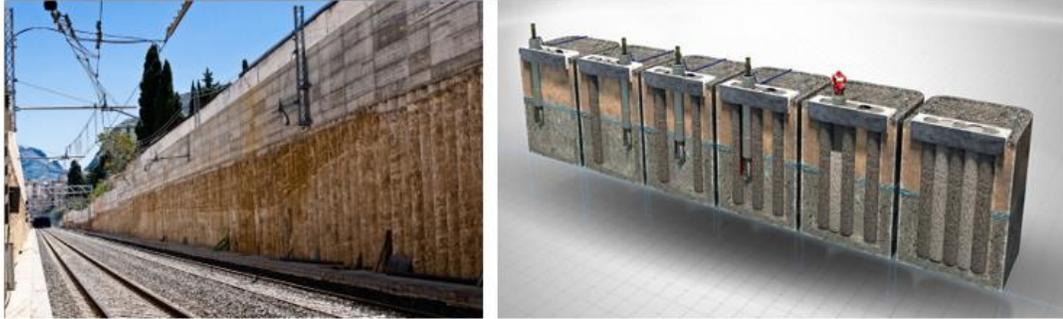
Concepto de pilotes secantes – Obra finalizada
